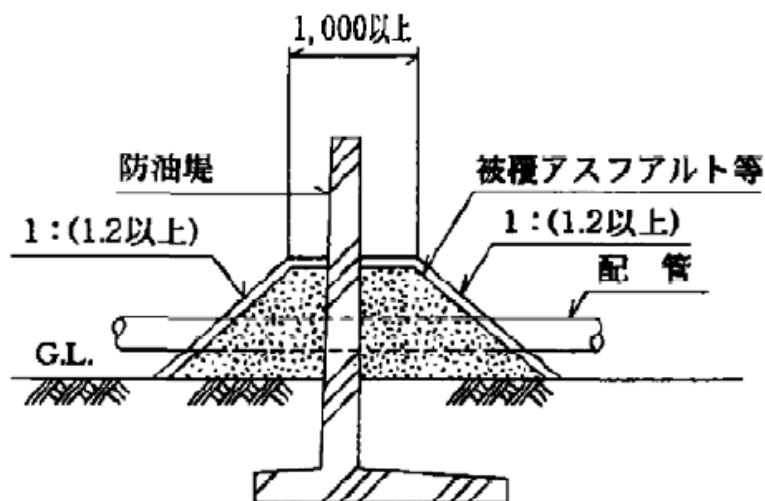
鉄筋コンクリートによる配管貫通部の保護措置の例
